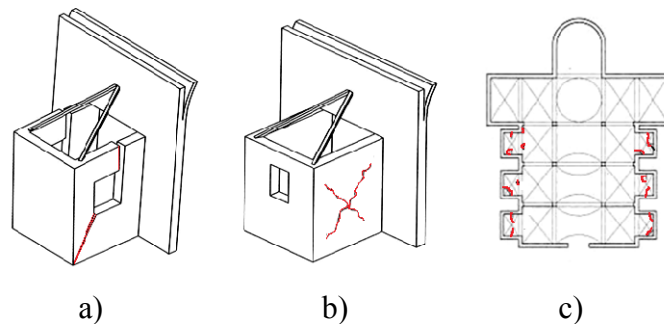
Mecanismos em capelas ou corpos adjacentes [Linee Guida, 2006]: a) Mecanismo 22; b) Mecanismo 23; c) Mecanismo 24.
